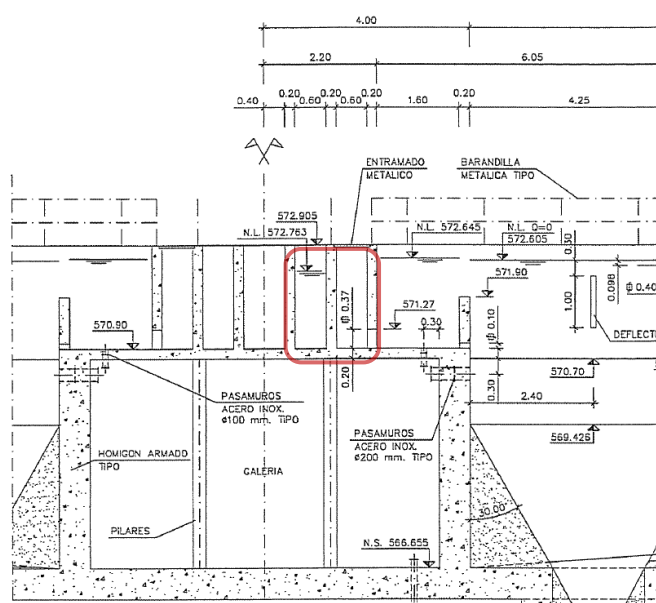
Dimensiones de canales de entrada a decantación primaria.
